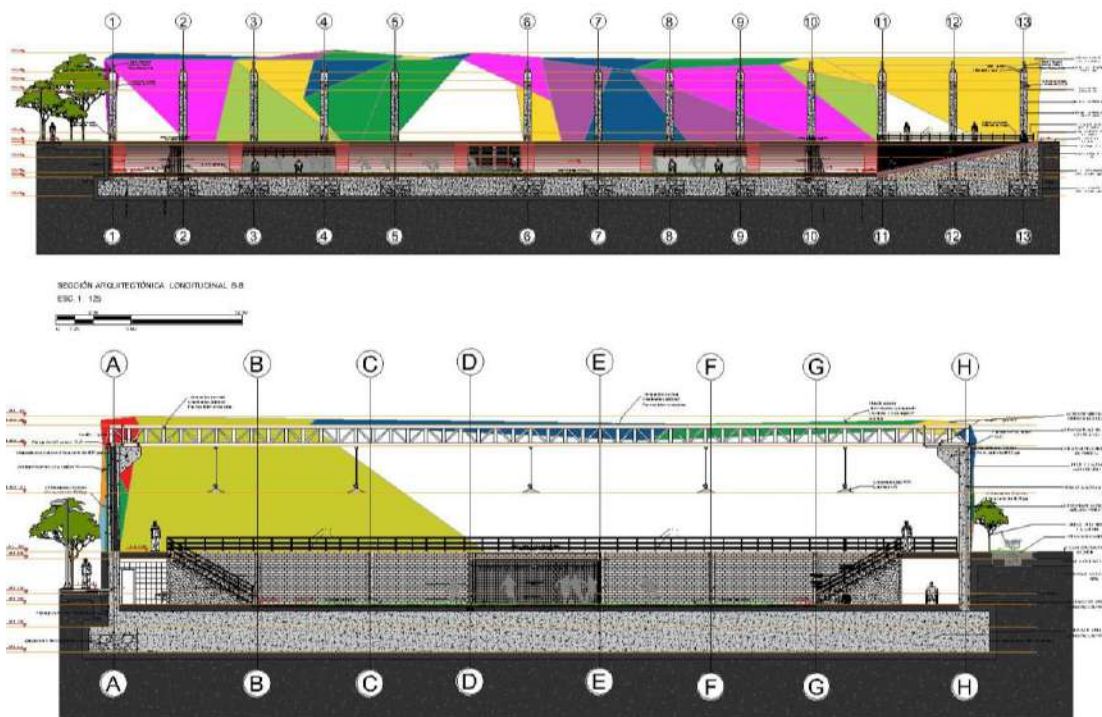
Secciones arquitectónicas longitudinales y transversales cancha de fútbol 9. Fuente: Elaboración propia 2021.
